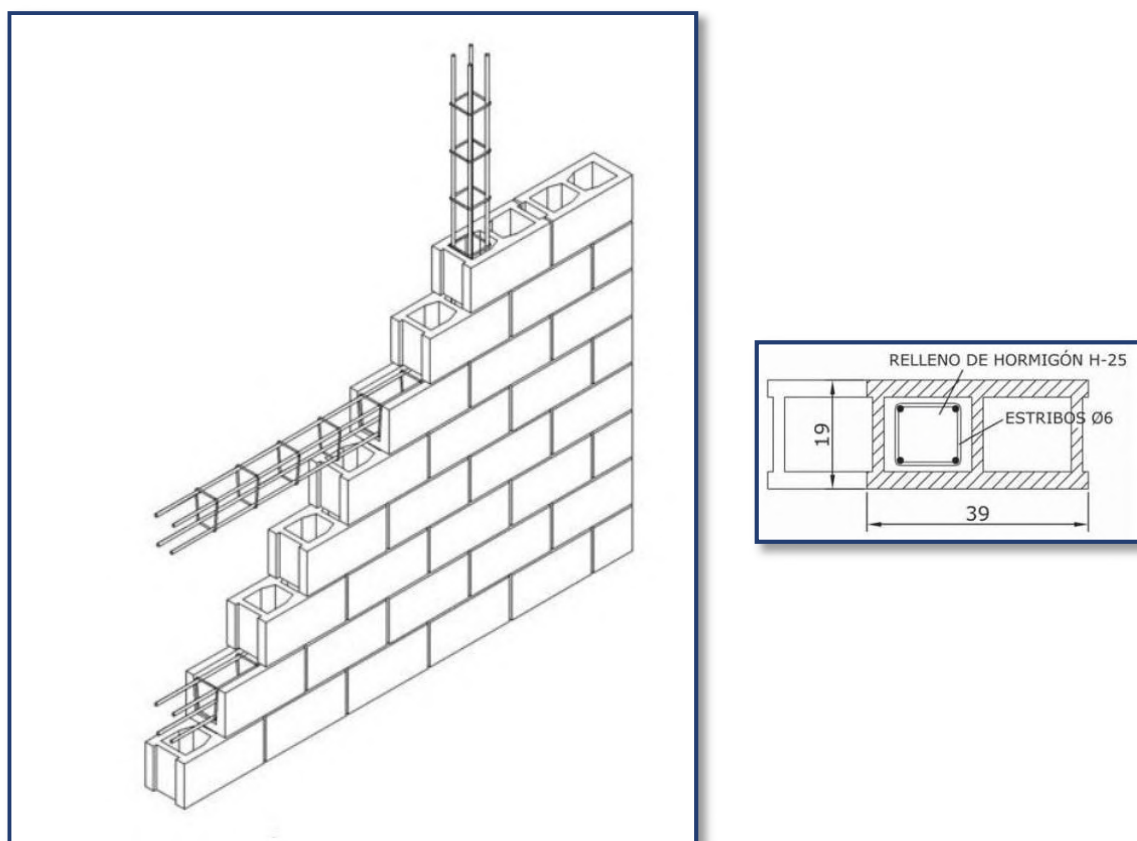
Muro de bloques de hormigón reforzado con armadura y detalles.
